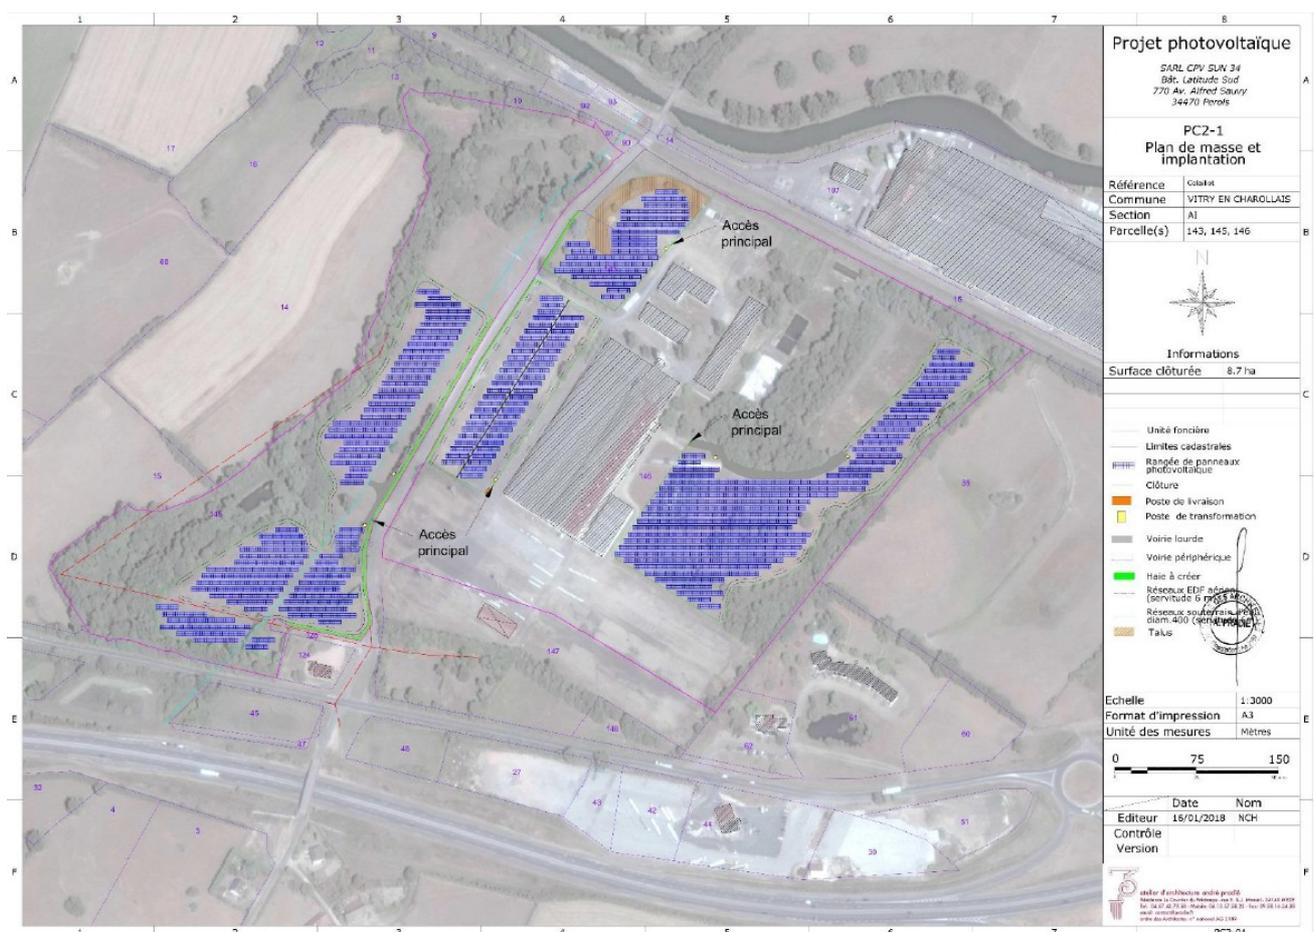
Plan de masse et implantation extrait du dossier de permis de construire.
